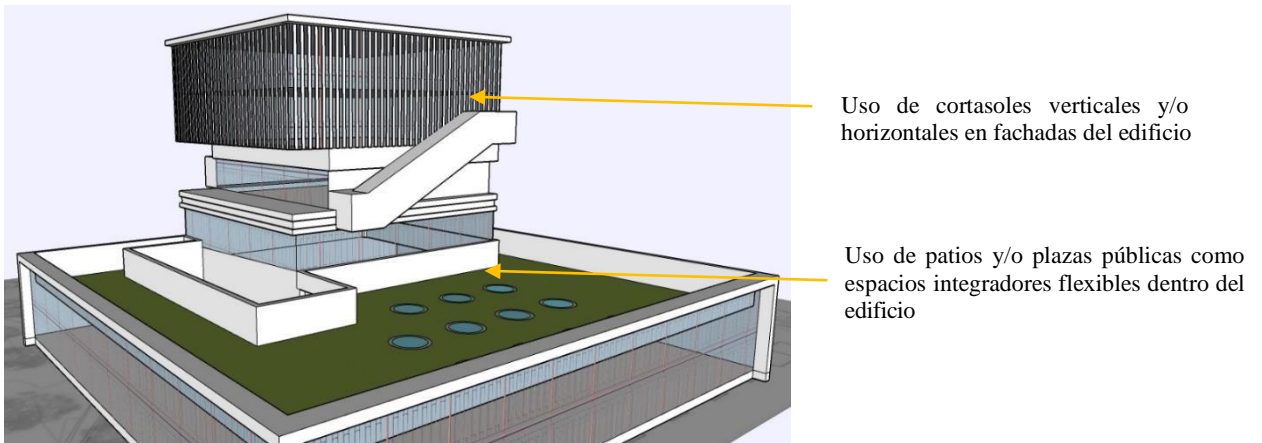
Vista isométrica de planta del edificio-ISOMETRIA 4
